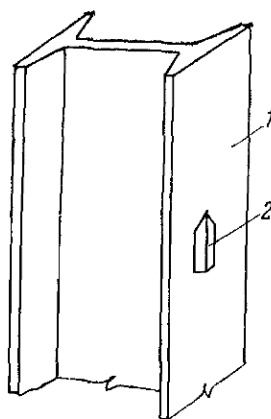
Схема установки осадочных марок на металлические конструкции
